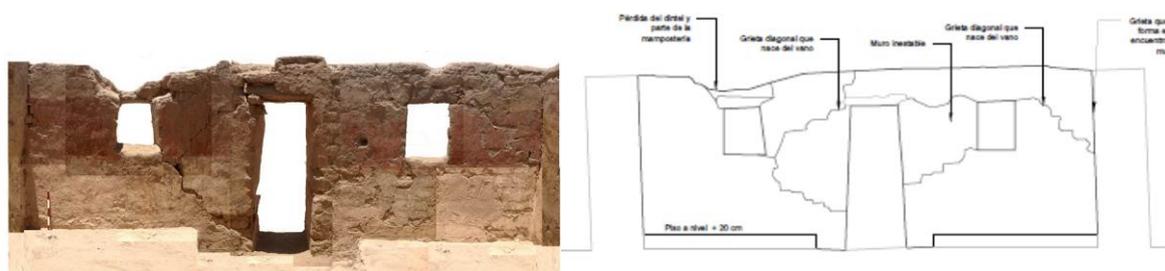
Plano de grietas del Recinto 62 en Tambo Colorado
